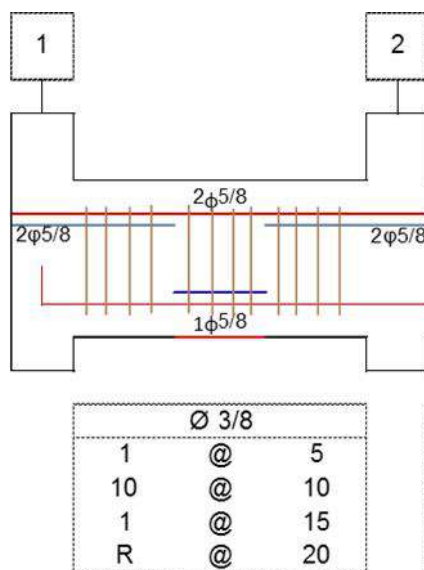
Diseño final de la viga V-102(0.25x0.50) m
